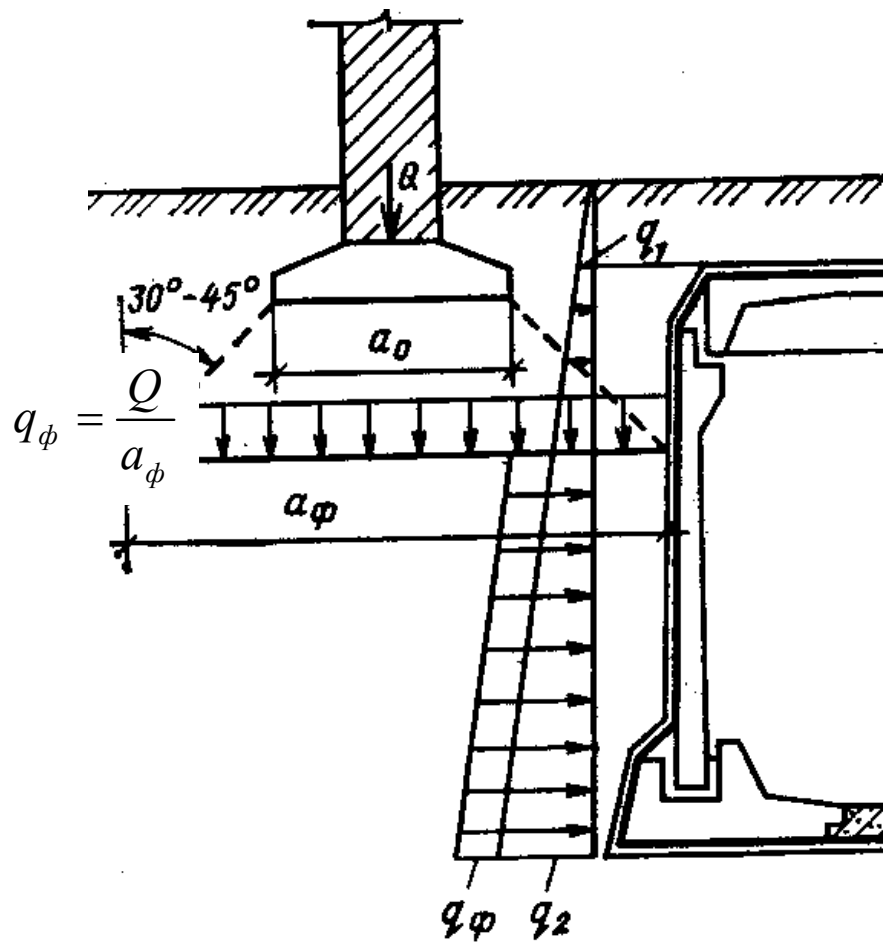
Схема определения давления на подземную конструкцию от фундамента здания
